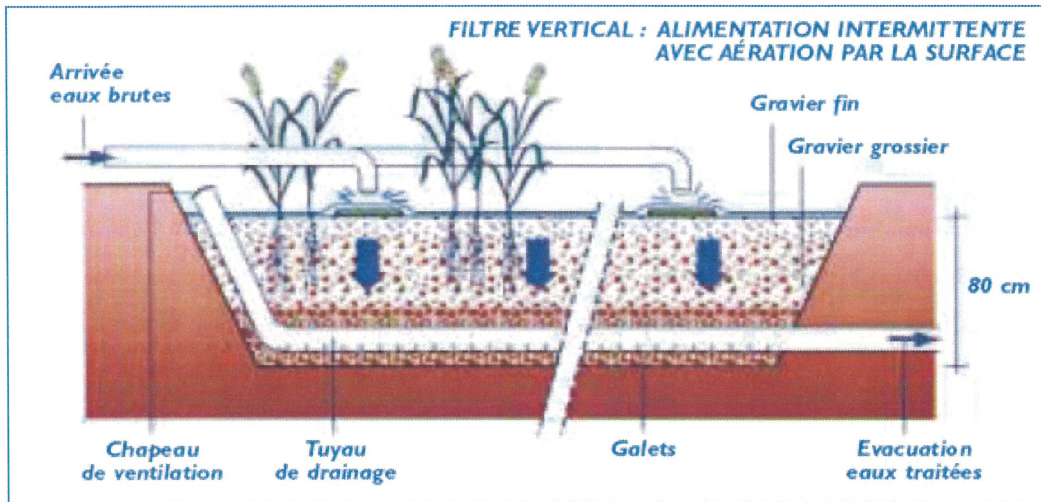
Coupe transversale d'un filtre planté de roseaux à écoulement vertical
